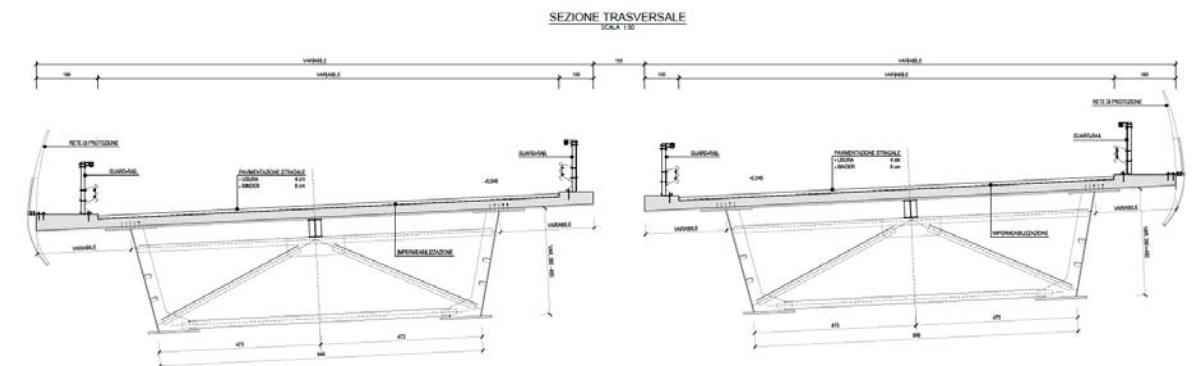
Ponte del Duchino: Sezione dell'impalcato
